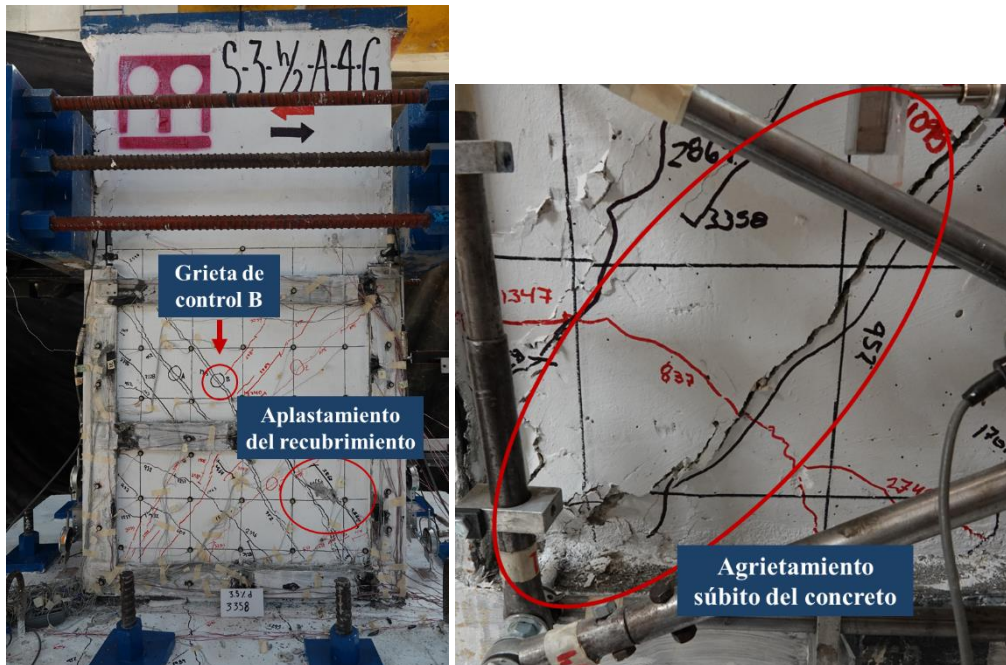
A la izquierda, aplastamiento del recubrimiento del concreto y grieta inclinada de control B en la cara Norte. A la derecha, agrietamiento súbito del concreto en la cara sur (ciclo 13, distorsión $+3.5\%$).
